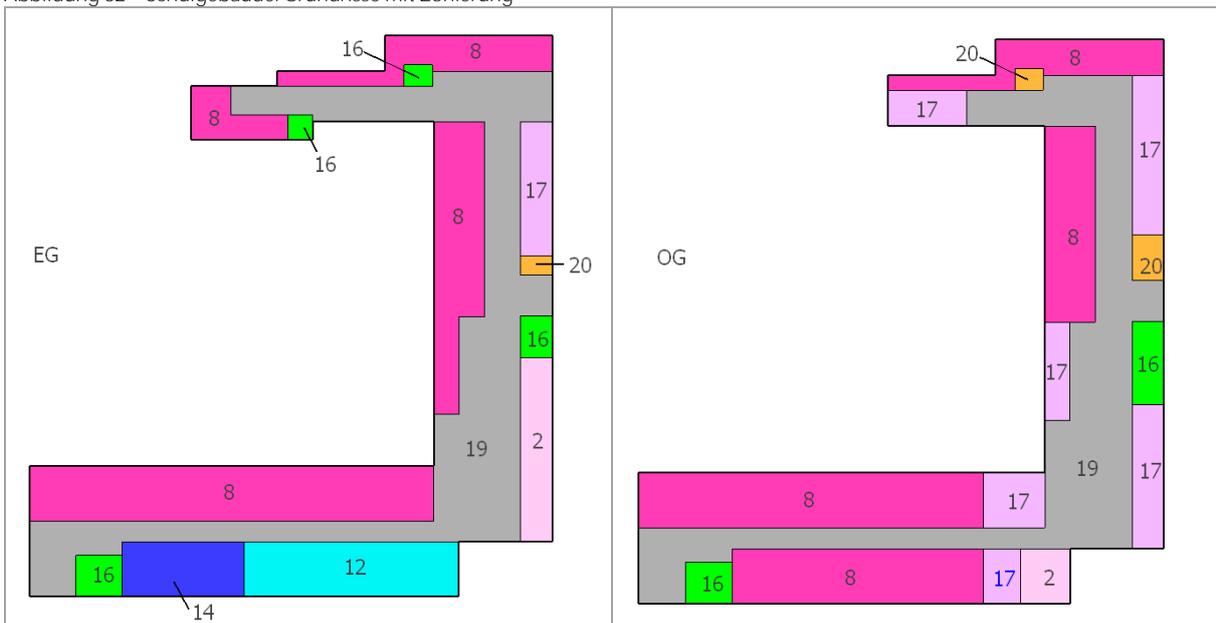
Schulgebäude: Grundrisse mit Zonierung
